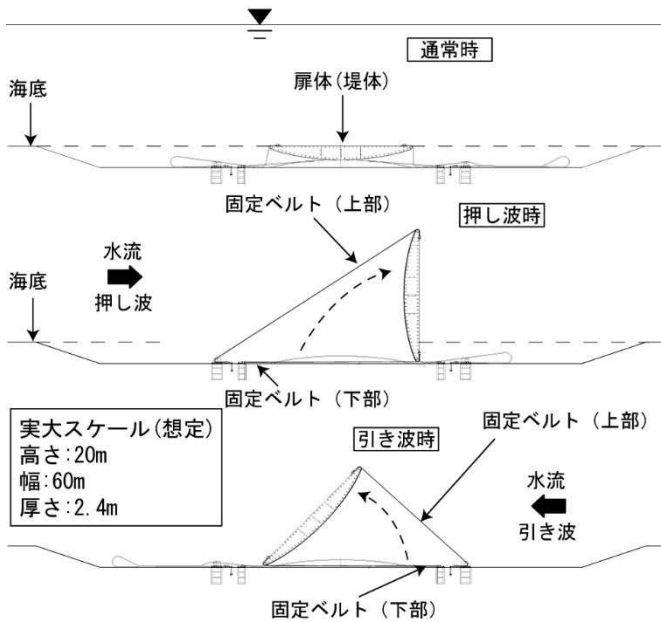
流起式可動防波堤の詳細断面図
